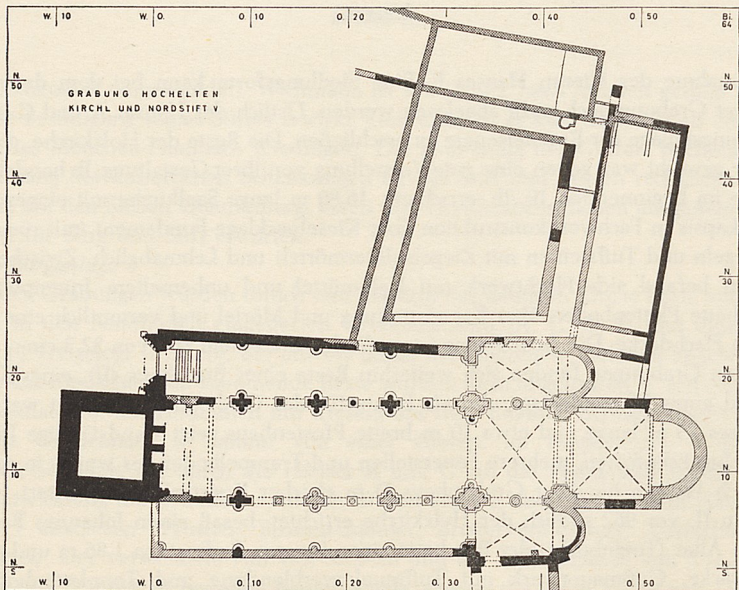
Abb. E Hochelten, Grundriß der romanischen Stiftsanlage mit späteren Umbauten.
